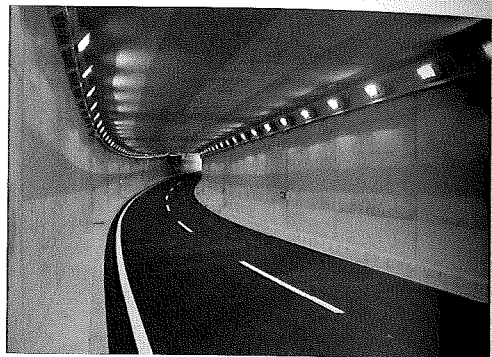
トンネル完成状況(ハーモニカ工法施工部)
